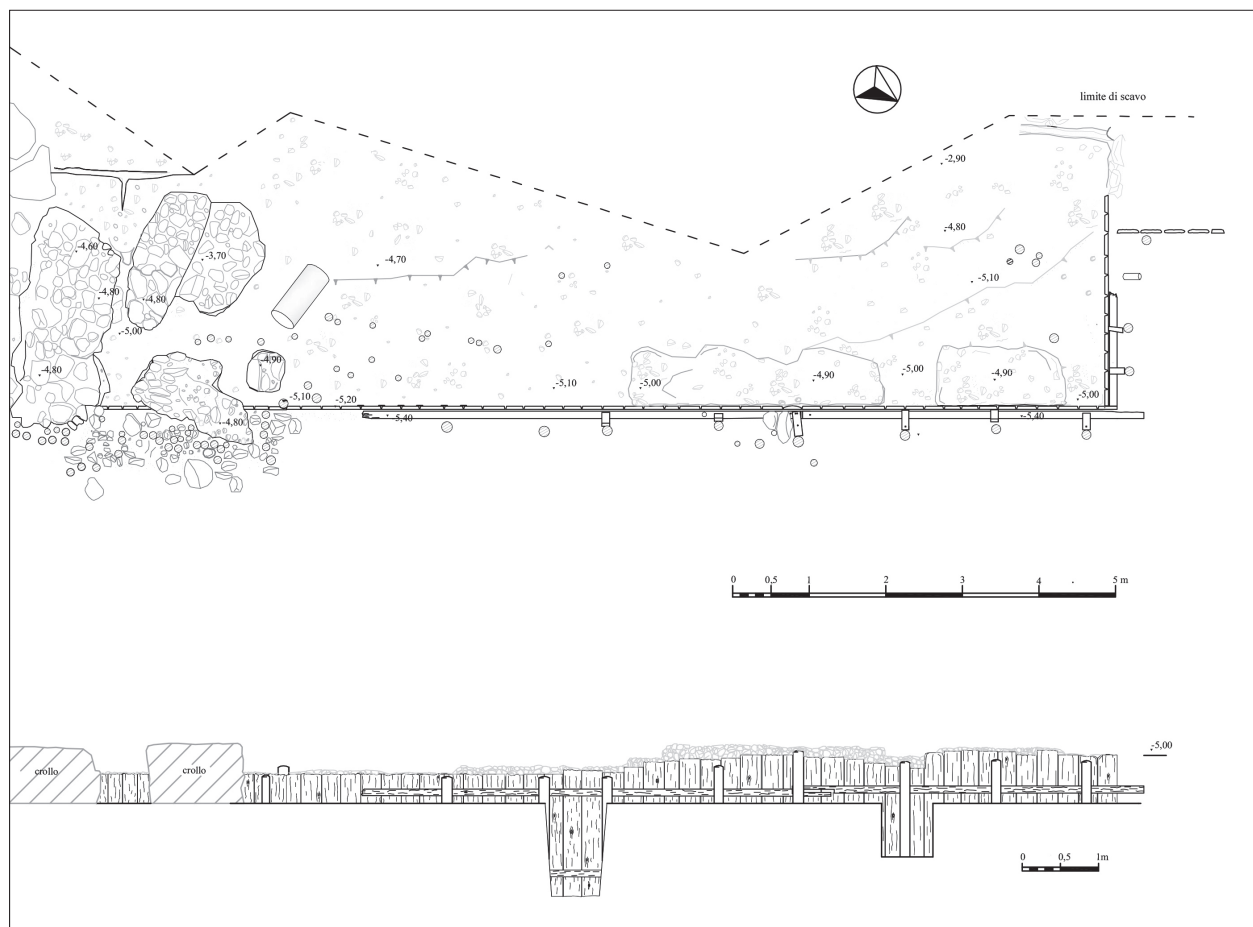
Banchina portuale: planimetria del settore settentrionale e prospetto Nord-Est.
